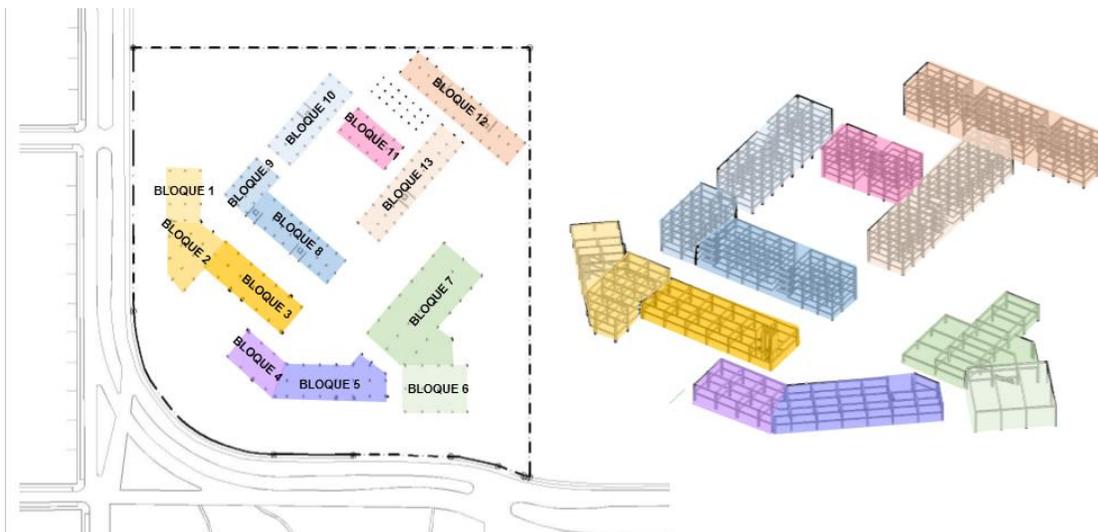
Esquema Estructural de la propuesta. Fuente: Elaborado por autores.
